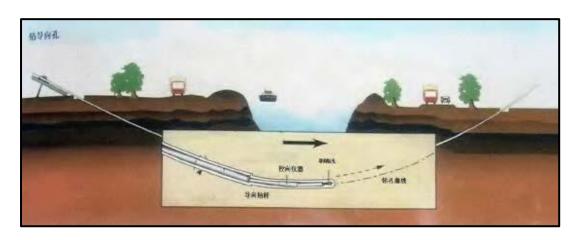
定向钻穿越施工钻导向孔过程断面示意图
